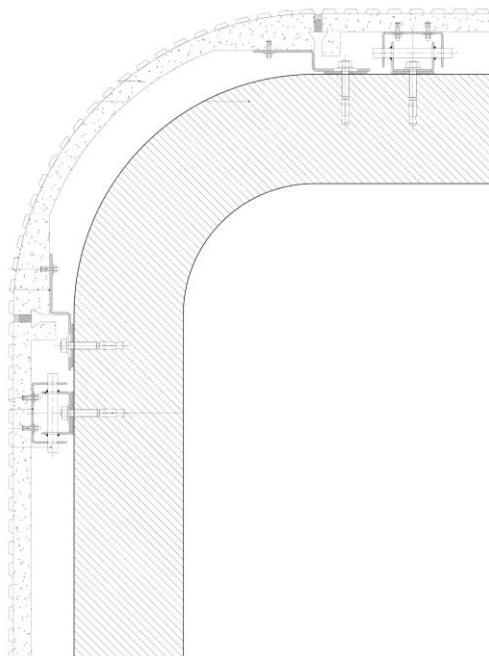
Detalle de las placas de la fachada. Escala 1/50.
